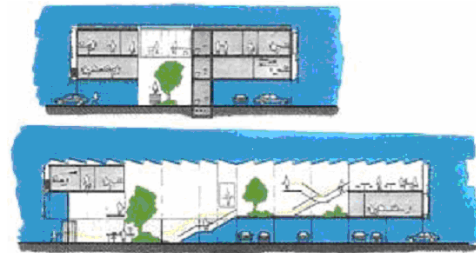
Bouwcentrum international. Die Außenwand ist eine hinterlüftete (unten offene, oben mit Klappen öffnende) Klimafassade, die Wand besteht aus elementierten Holzrahmen mit Polycarbonatfassade, Wärmedämmung und innen Holzpaneelen.
